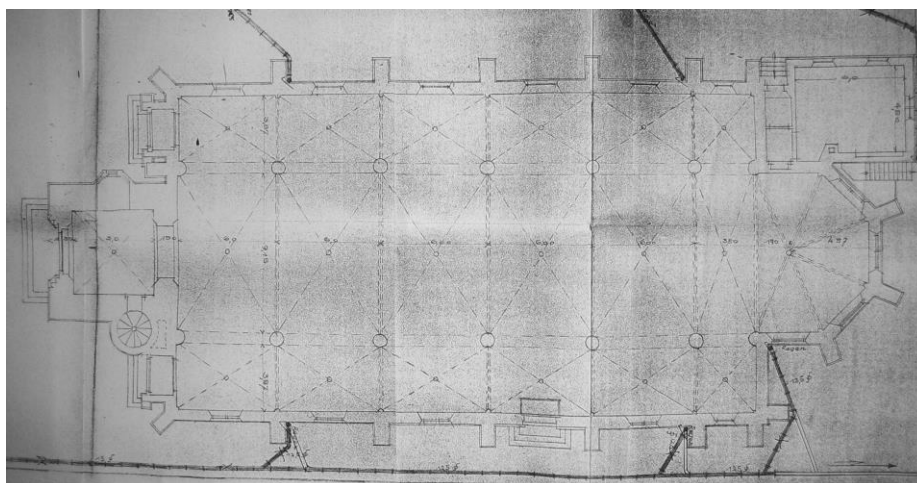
Grundriss der Kirche zur Entwässerungsmaßnahme, Baugeschäft Joh. Wienke, Herne, Mai 1938
